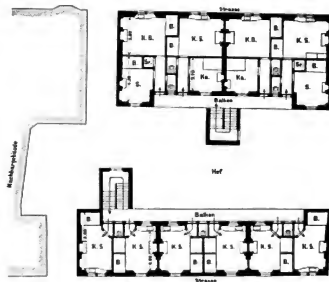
Balkonsystem, Ein- und Zweizimmerwohnungen. Erstes Obergeschoss.
